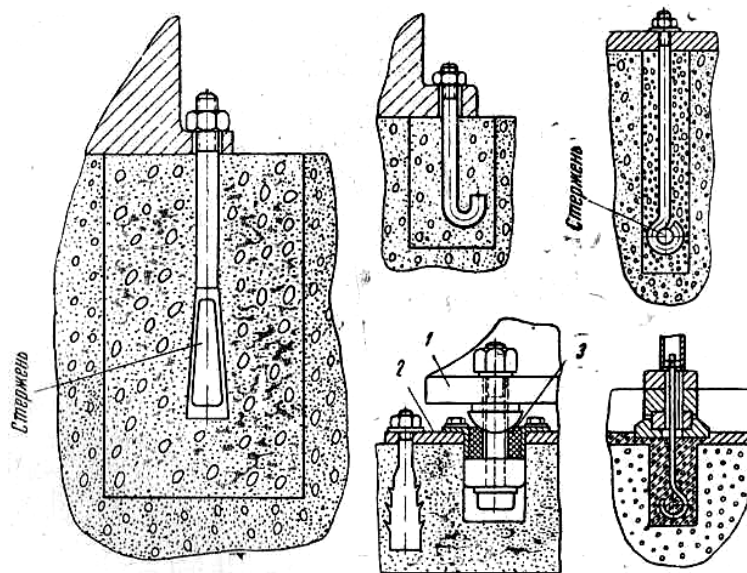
Примеры схем организации элементов крепления в фундаментах
